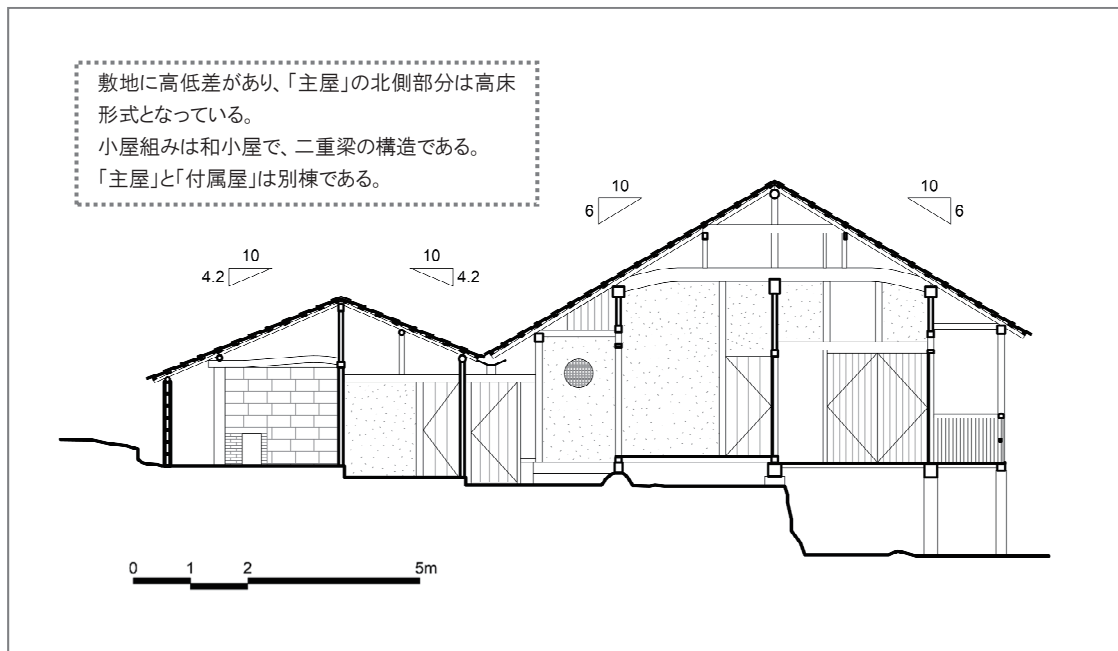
沖山剛造家住宅 断面図 (実測調査による)
